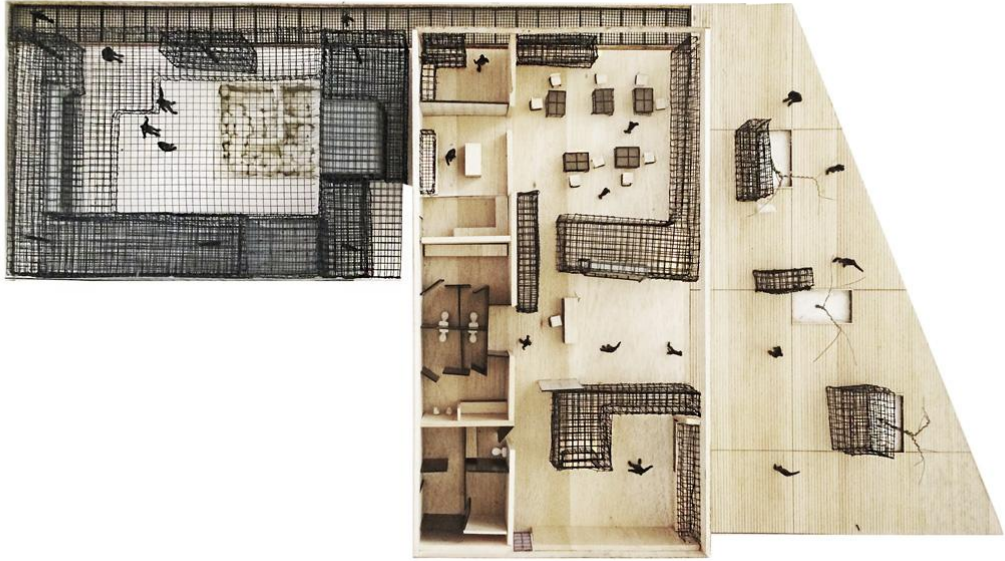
Maqueta de desarrollo. Vista desde planta. Fuente propia.
